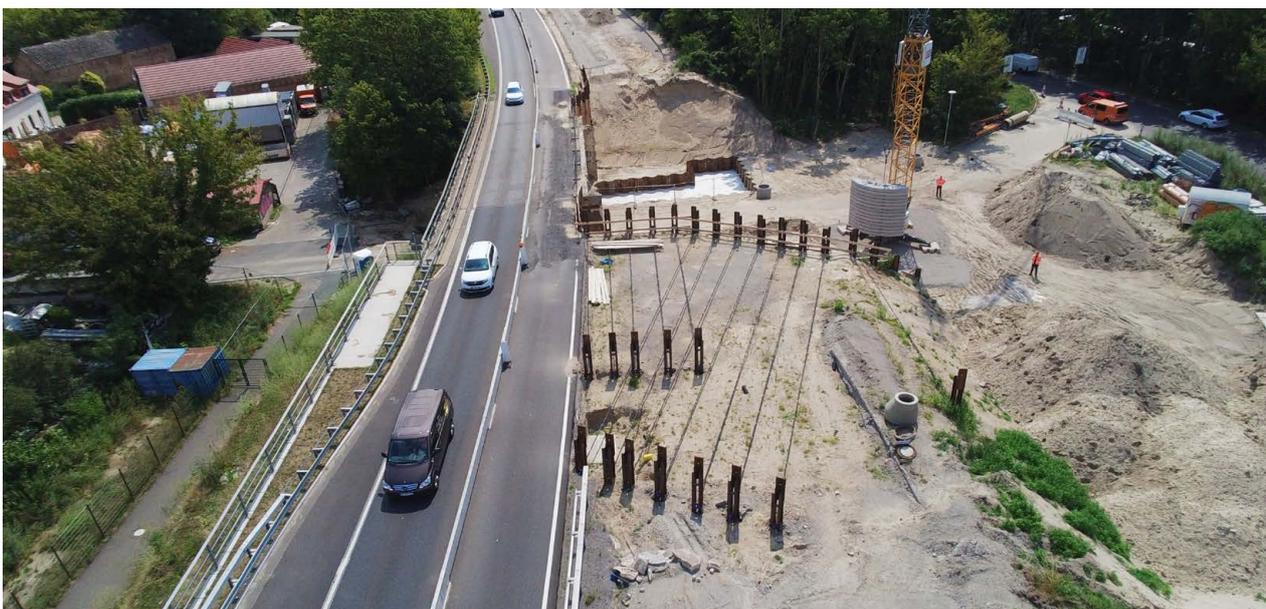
Betonage Friedrich-List-Straße, Foto: LS
